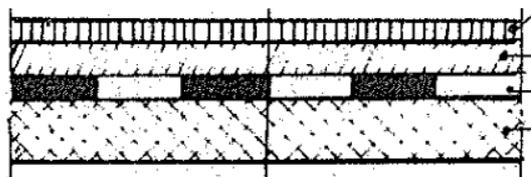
Schemadarstellung - Aufbau Geschosdecke (Fa. DOM Sarajevo)
